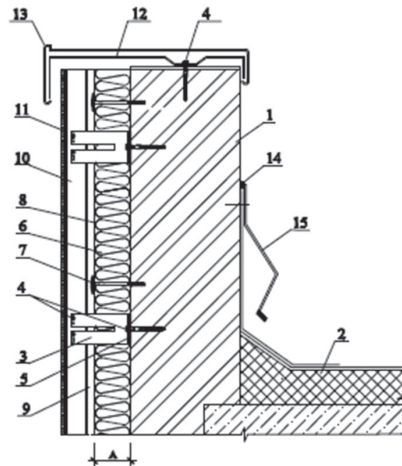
Конструктивна схема влаштування теплоізоляції паропету
